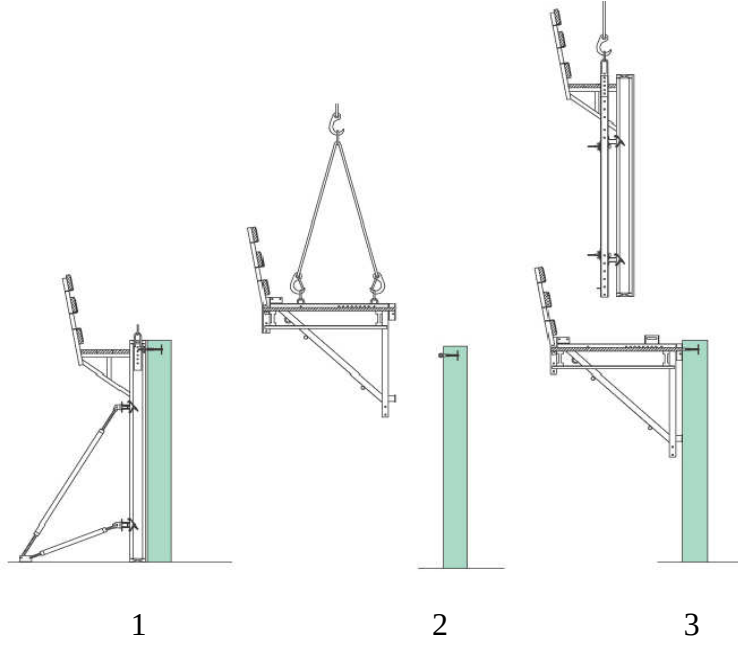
Tırmanır kalıplarda bir önceki betona yapılan ankrajlama
